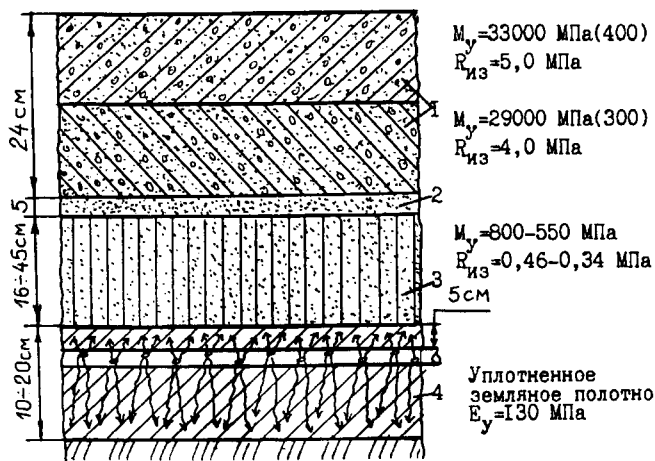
Конструкция усиленной жесткой дорожной одежды: 1 — двухслойное цементбетонное покрытие; 2 — выравнивающий слой; 3 — основание; 4 — дополнительное основание.
